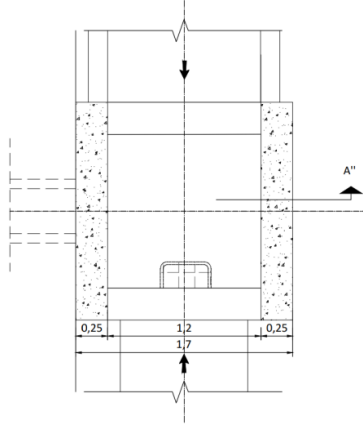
Detalle tipo 1 – (Perfil) Obra de drenaje transversal (ODTL) arqueta-boquilla.
